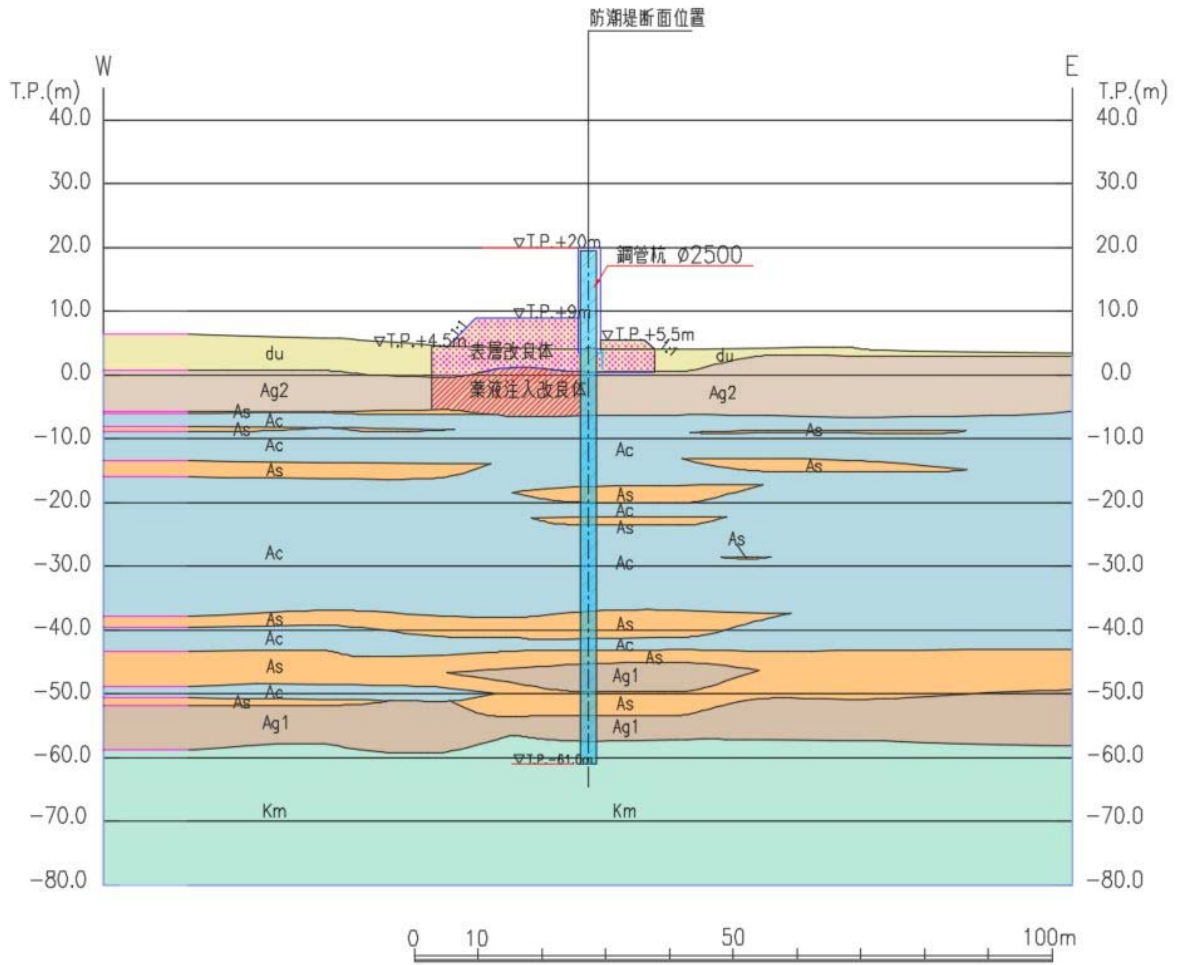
10. 5-29 (3) 鋼管杭鉄筋コンクリート防潮壁 断面図 (断面③)
